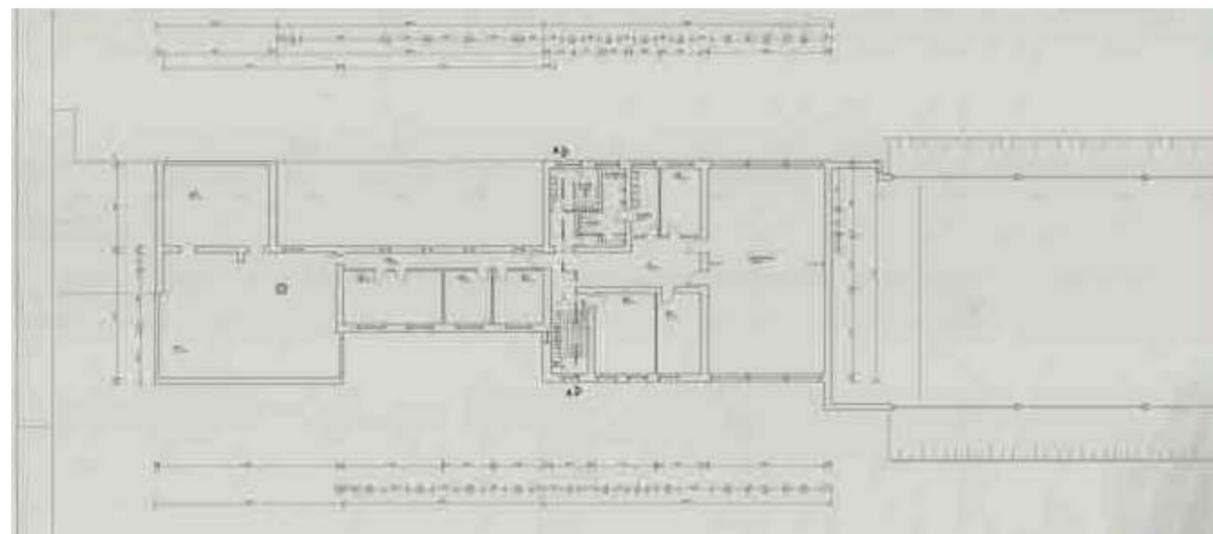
Gesamtanlage: Plan mit Grundriss des 1. Obergeschosses ohne die Zollräumlichkeiten im Süden, 1998
